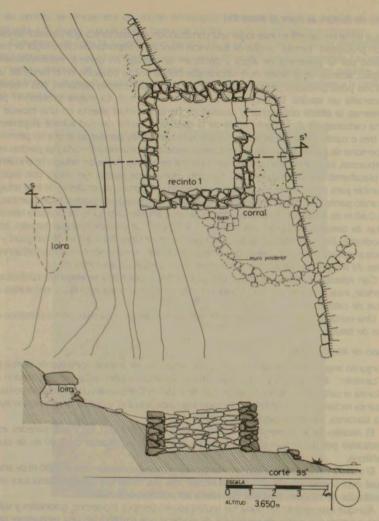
TAMBO DE RIO FRIO. Planta y corte-elevación.
